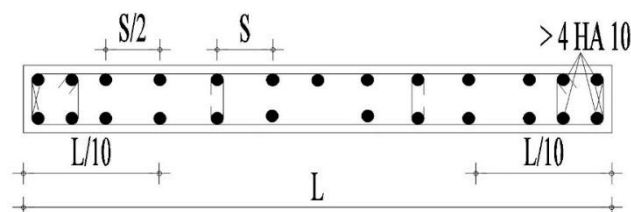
Disposition des armatures vertical (vue en plan)
